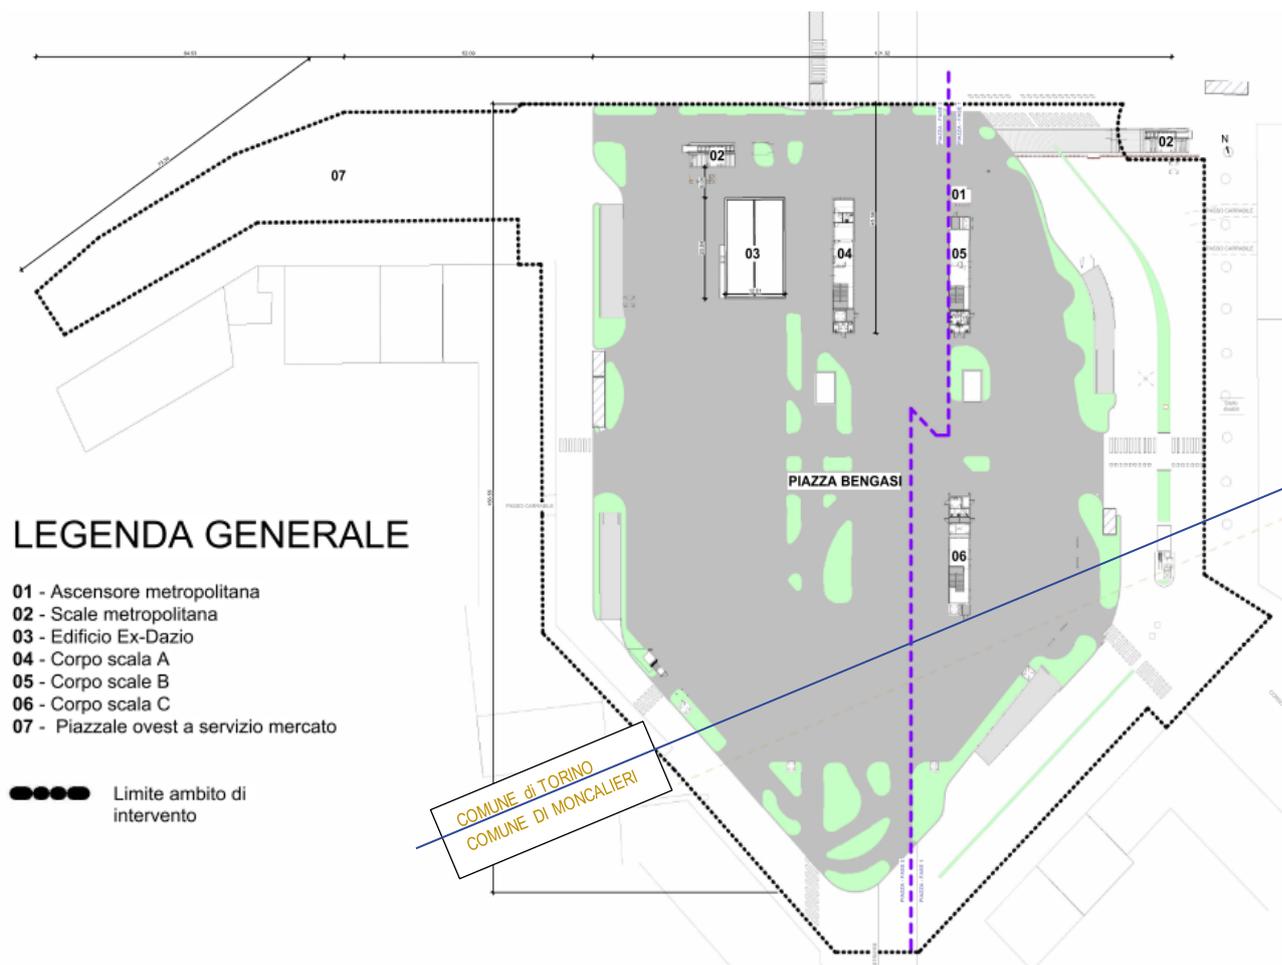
Planimetria dell'ambito d'intervento (l'edificio ex dazio è escluso dall'intervento)
